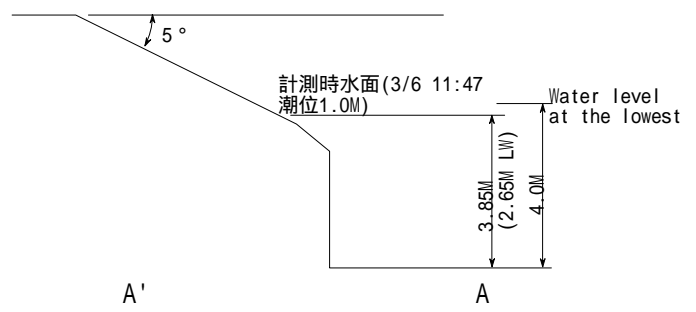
ネイアフ埠頭断面図 (A-A' 断面)
